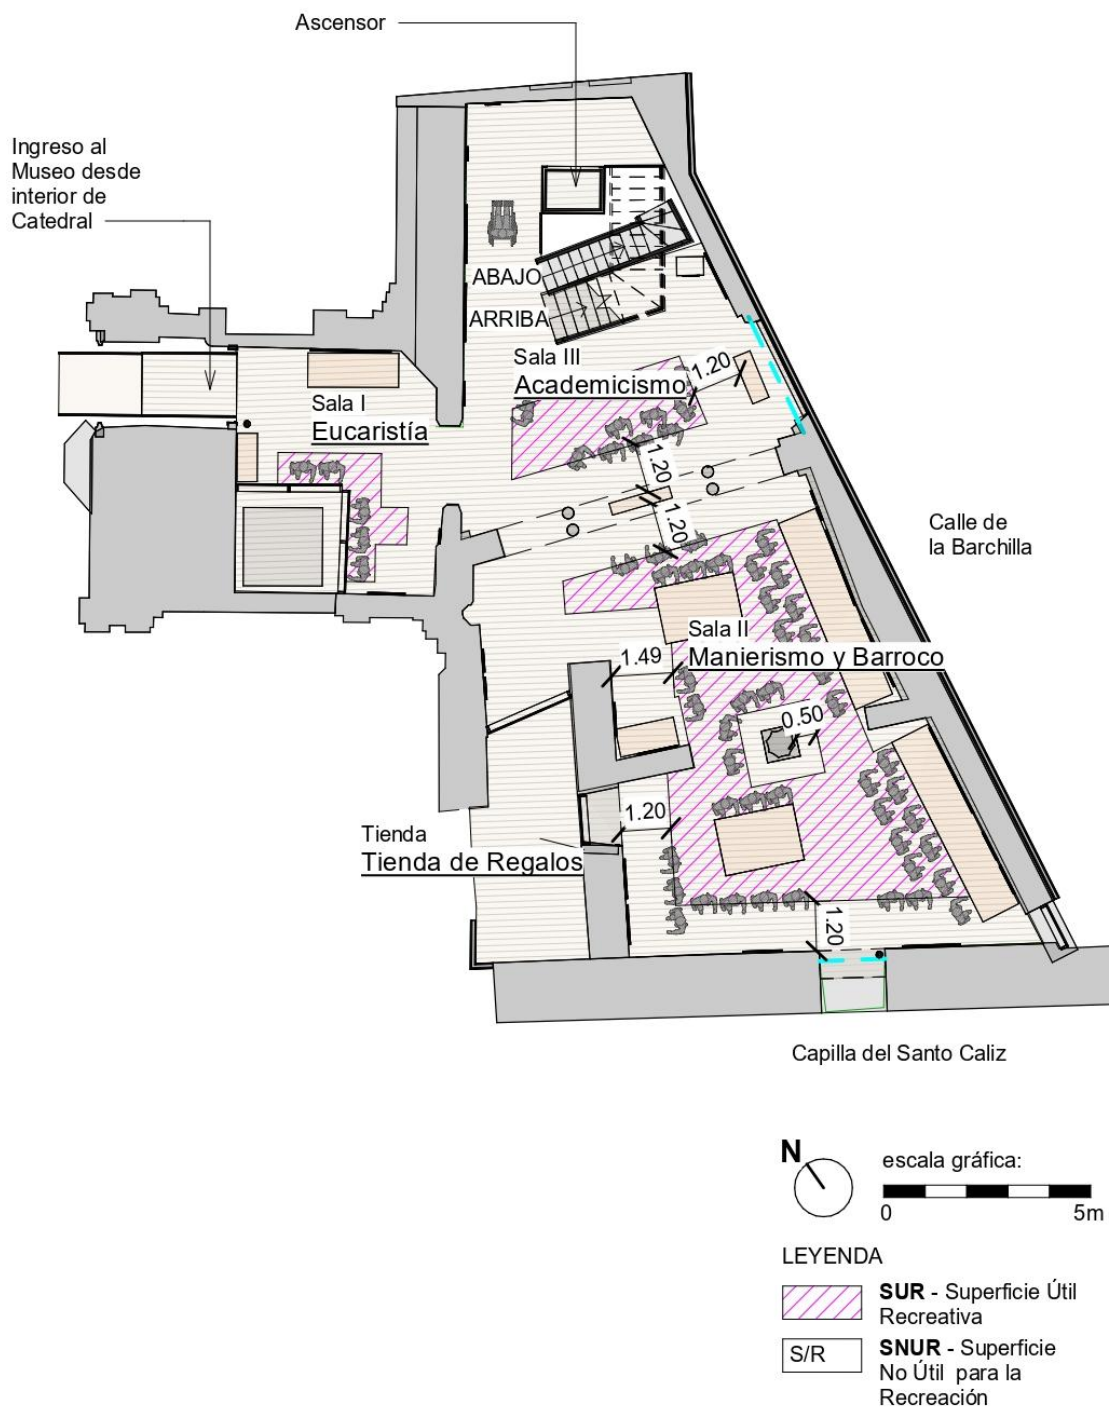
Planta Baja del Museo. Cálculo CCR. Elaboración propia.
